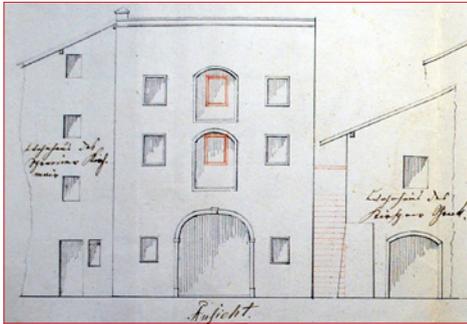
Das erste Feuerwehrhaus der Stadt, erbaut ab 1828 (Plan von 1864)
